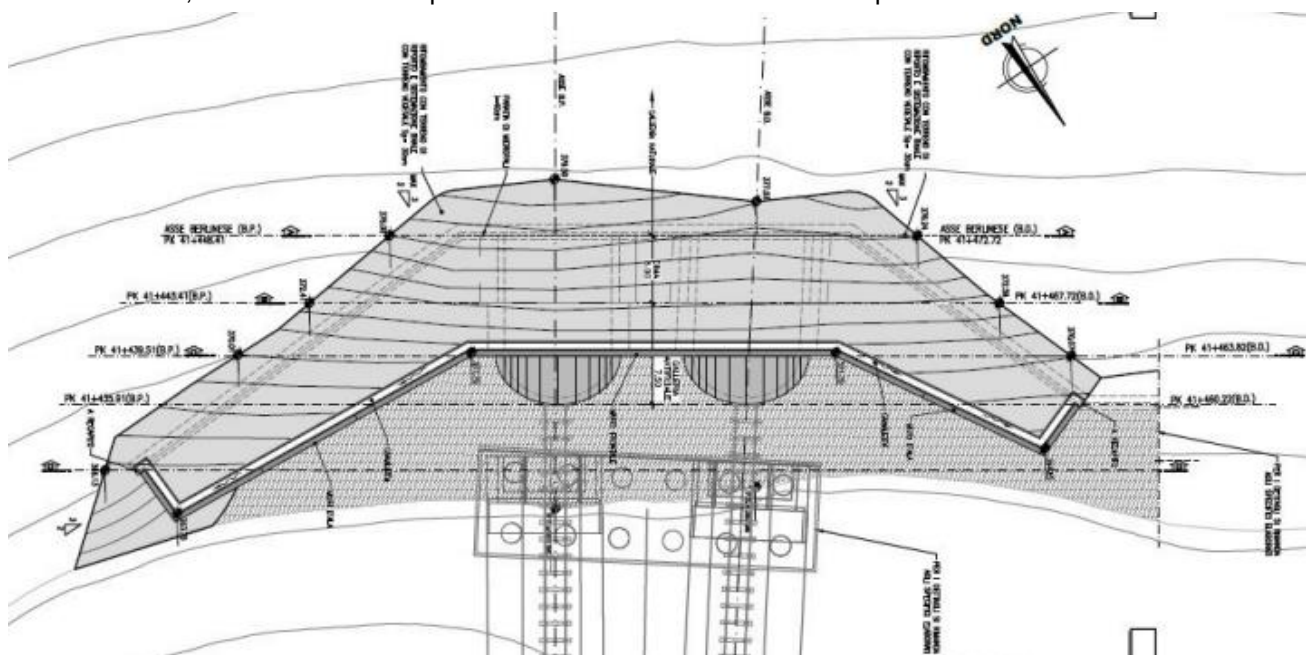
Planimetria delle opere di imbocco della galleria Hirpinia lato Bari – Configurazione definitiva
